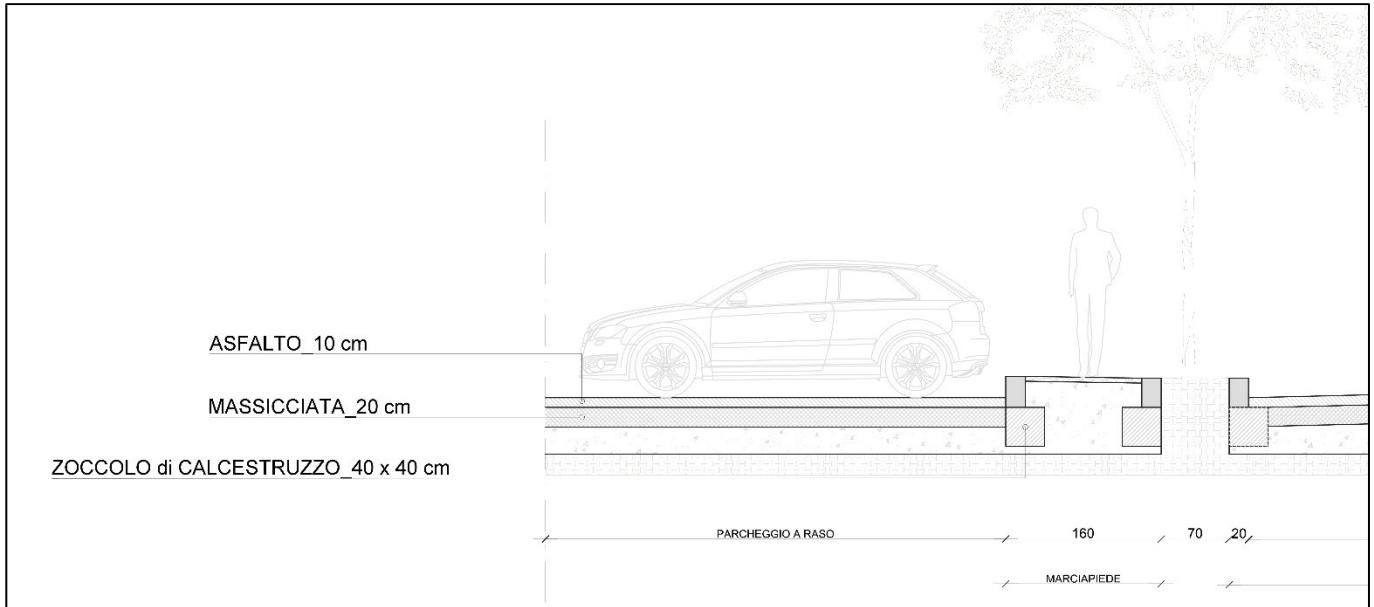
DETTAGLIO - SEZIONE T.3 SUB-AMBITO B.2
